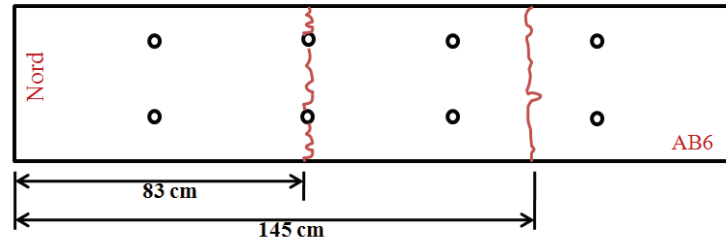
Relevé des fissures pour la poutre AB6
